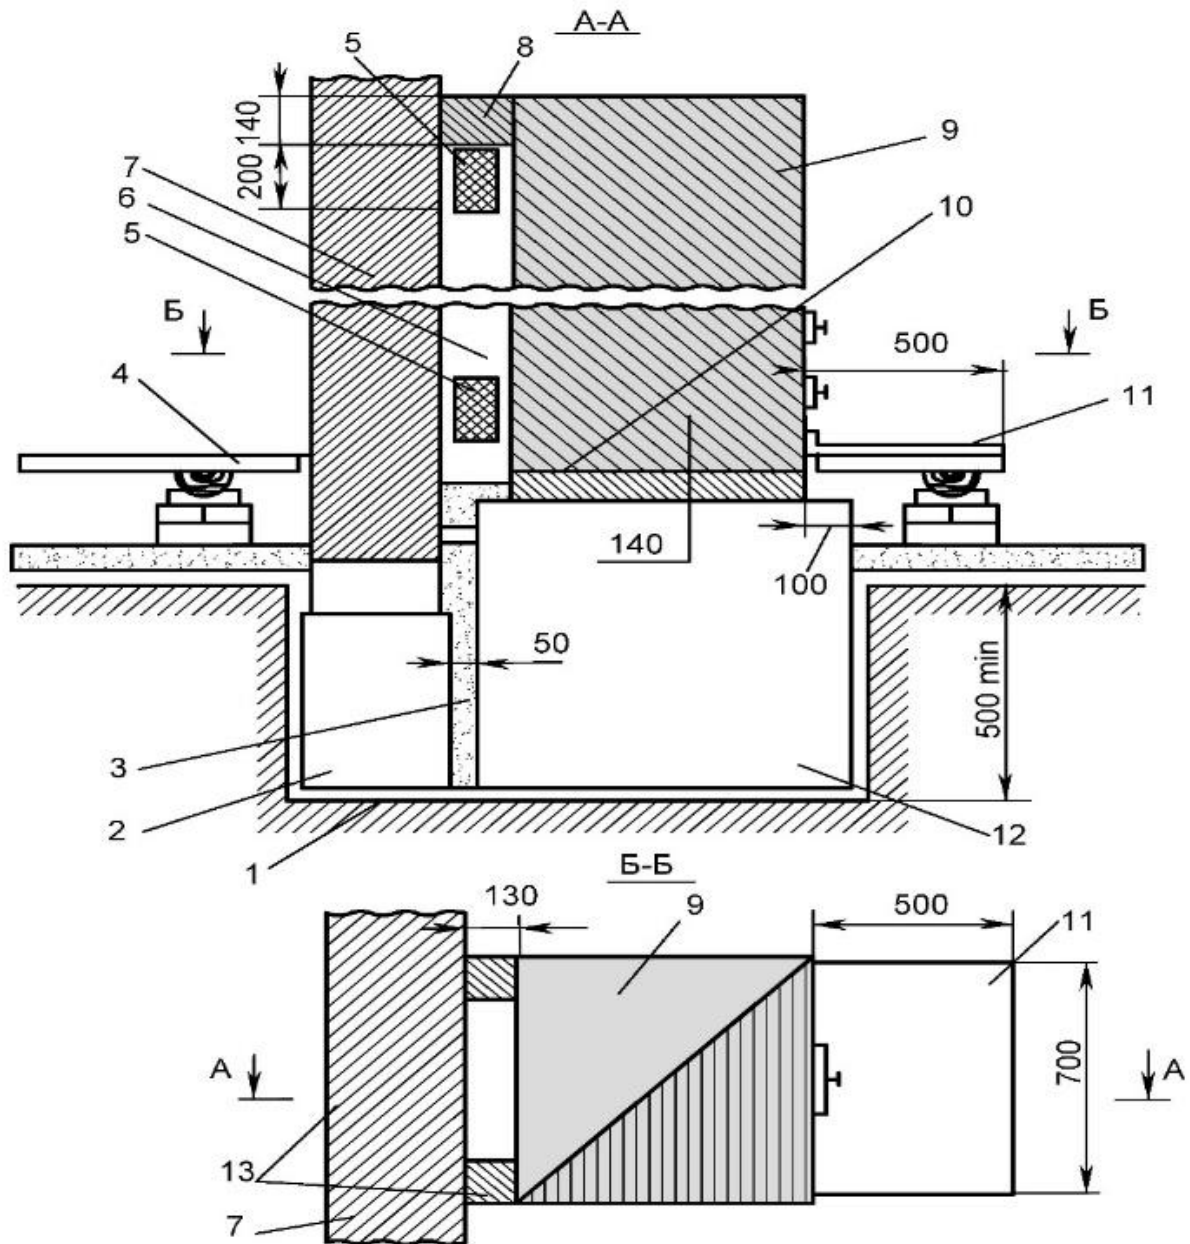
Конструкция фундамента печи, расположенной у внутренней кирпичной стены:
